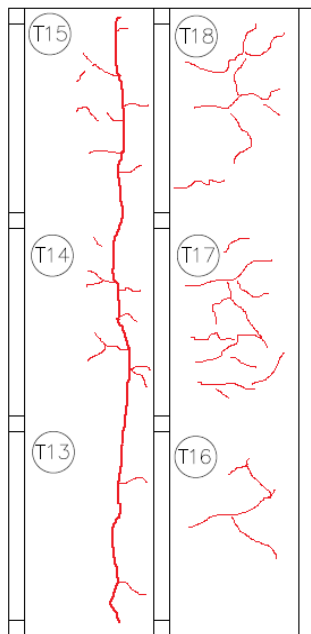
Ubicación de fisuras en Tablero del margen izquierdo
